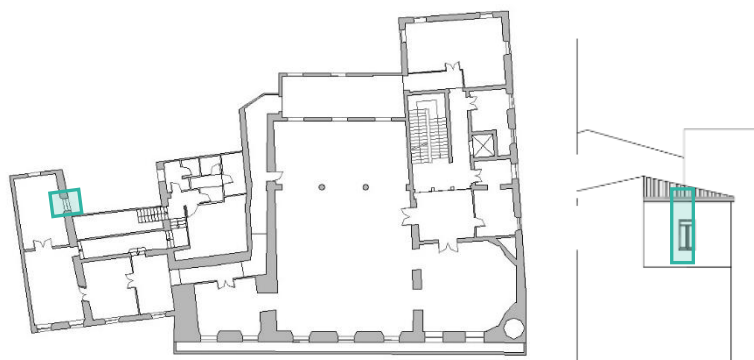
Individuazione macroelemento, pianta e prospetto
